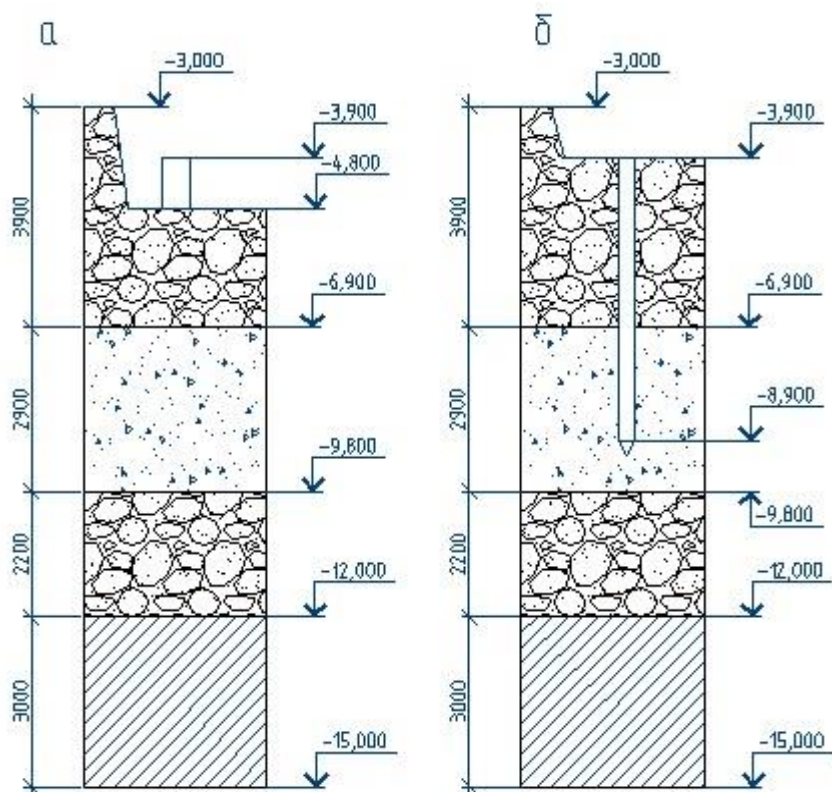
а) схема фундамента мелкого заложения; б) схема устройства забивной сваи
